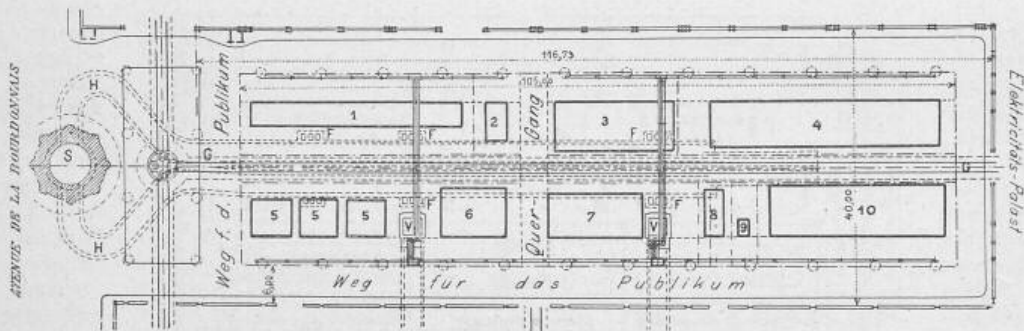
Grundriss des Kesselhauses «La Bourdonnais». 1:1000.
